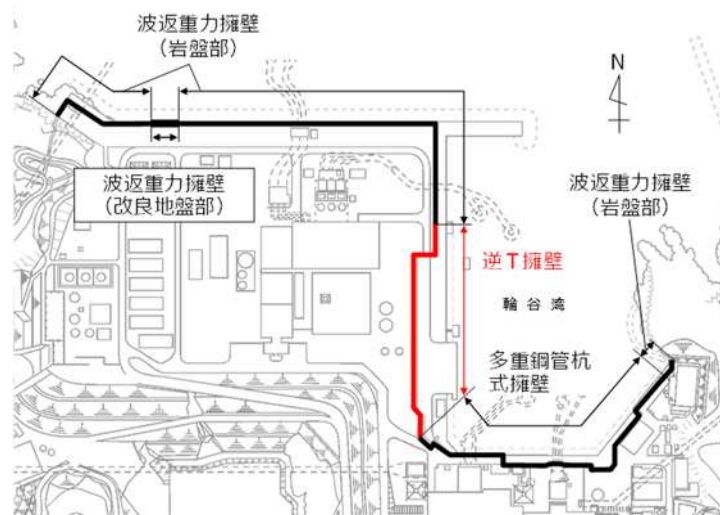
防波壁（逆 T 擁壁）の平面配置図
